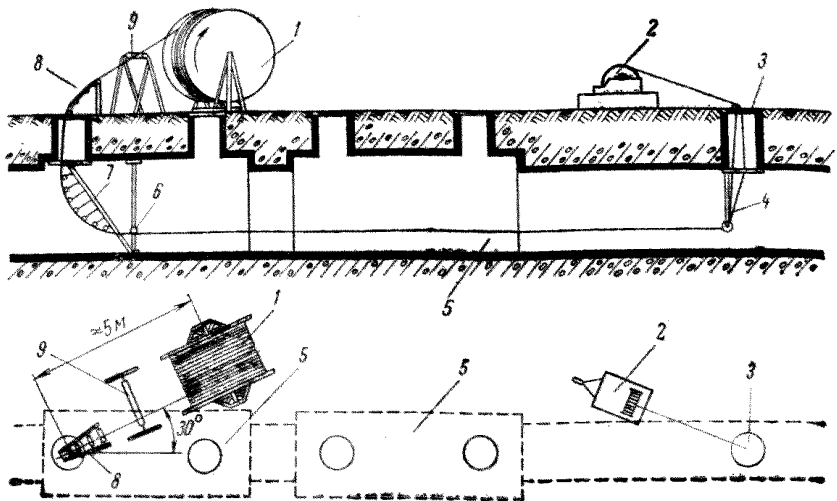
Схема прокладки кабеля в туннеле на участке между двумя камерами
